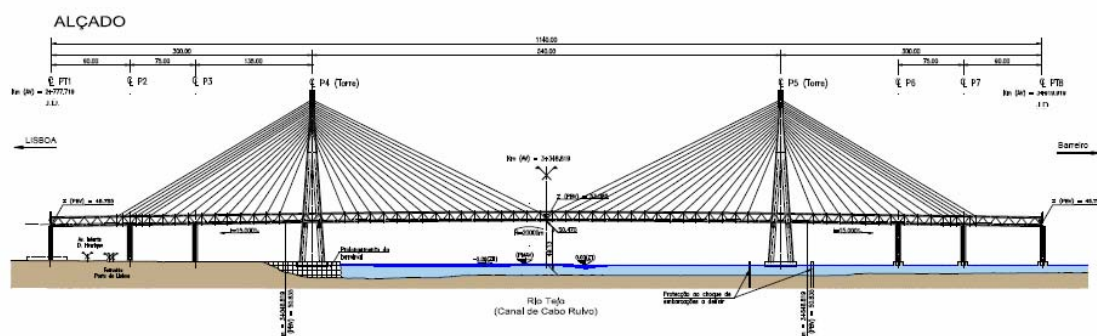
Solução Chelas-Barreiro (Fevereiro de 2008), alçado da ponte principal atirantada
